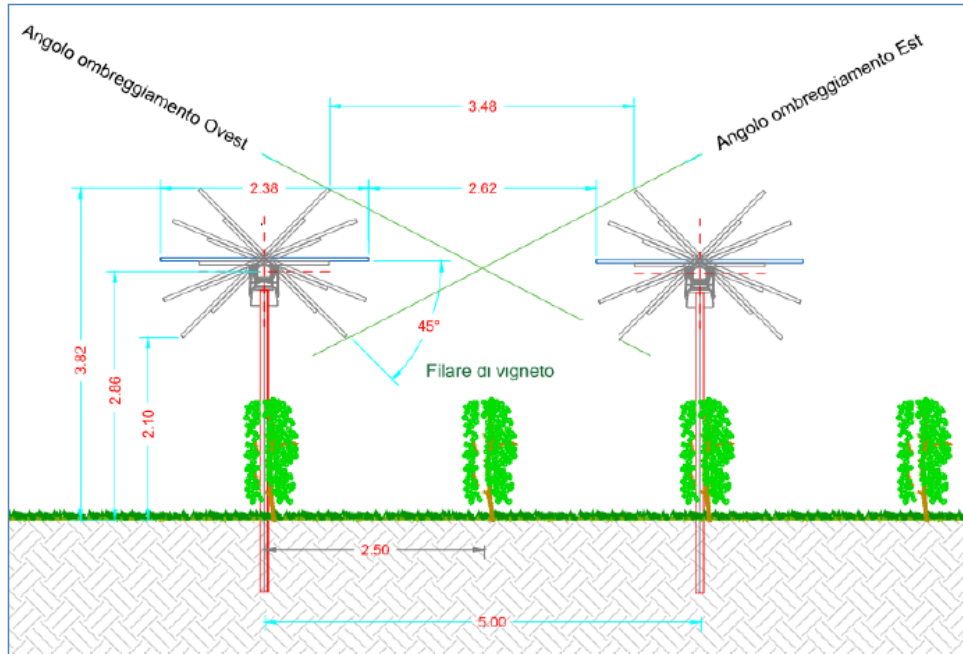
Sezione trasversale tipologica struttura Tracker con vigneto
